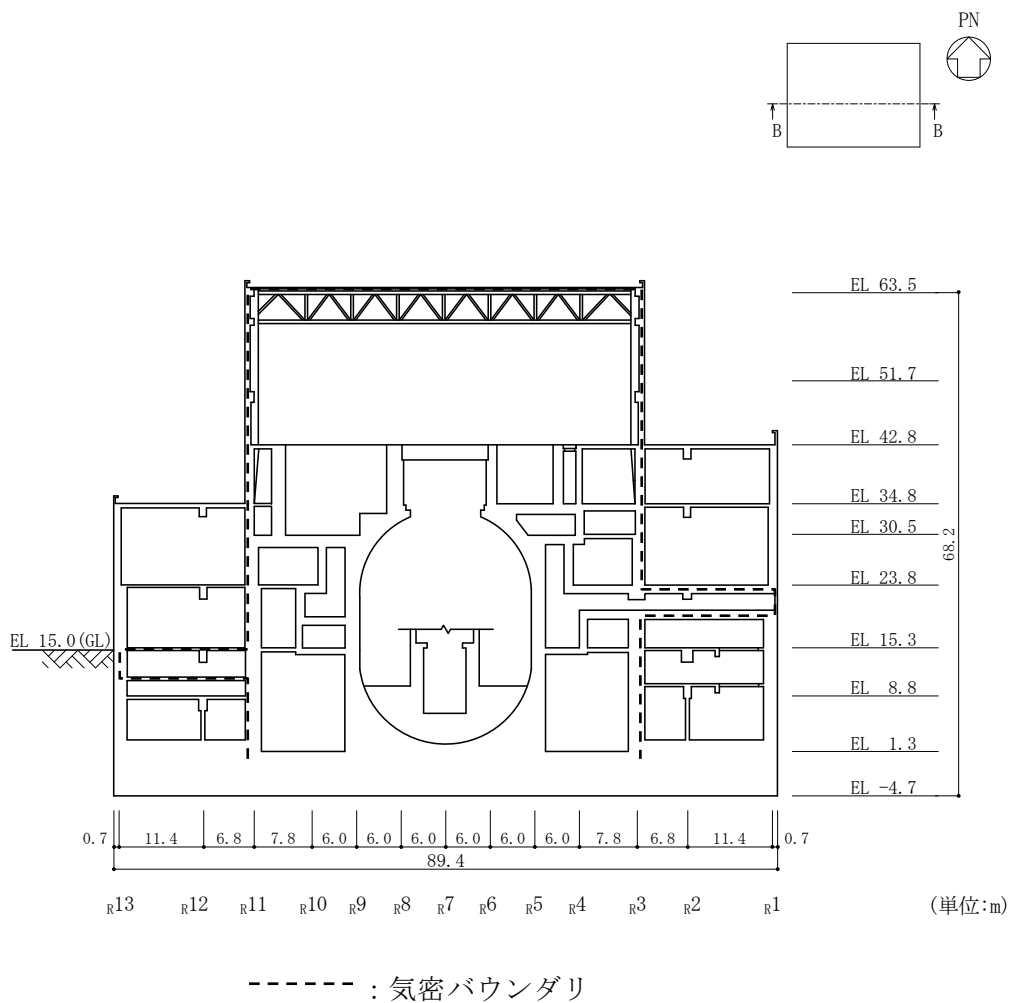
(2) 原子炉建物原子炉棟（二次格納施設）の概略断面図（B-B 断面，EW 方向）
